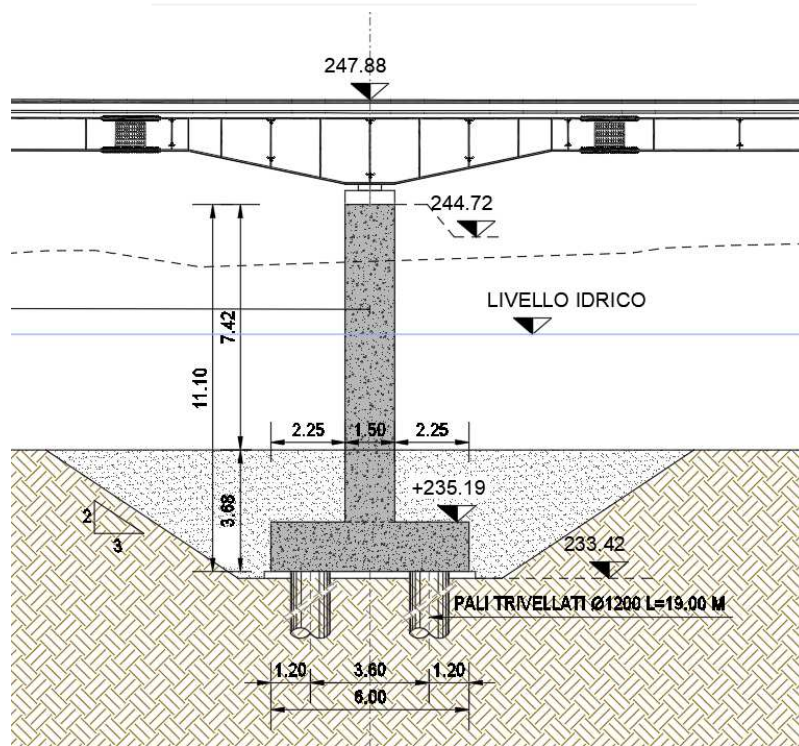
Sezione di posa della pila P1 e P2 del viadotto "VASCHE DI SPAGLIO - VI04".
